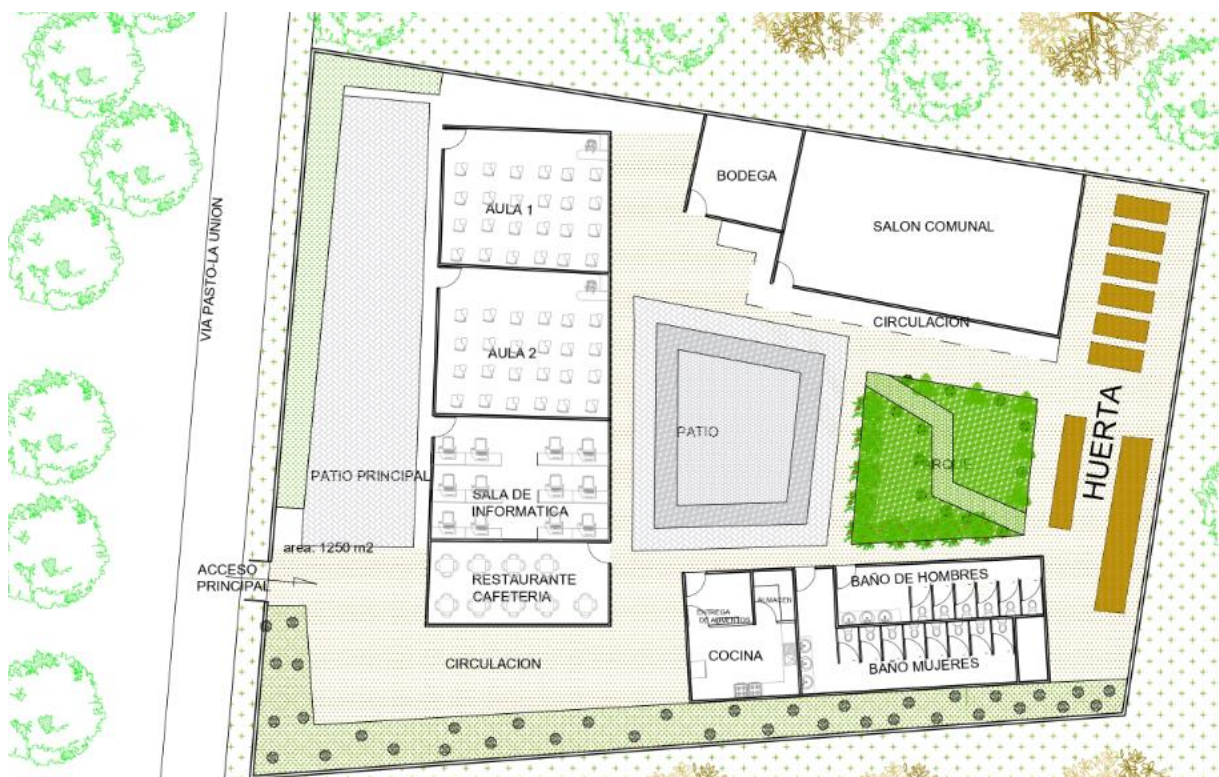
Centro Educativo el Pedregal – Planta primer piso
